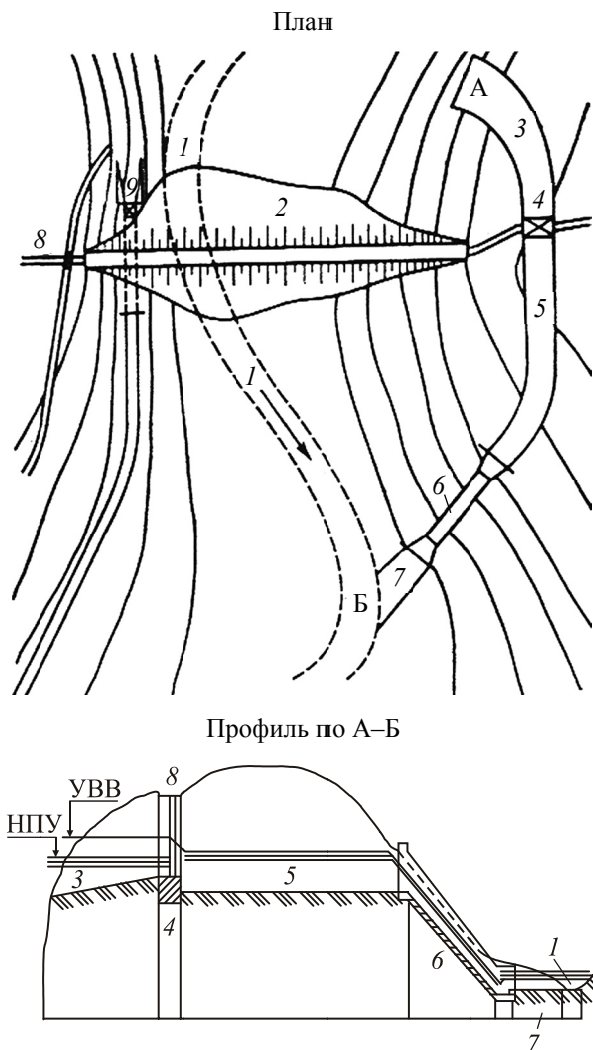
Схема гидроузла с грунтовой плотиной и открытым береговым водосбросом и водовыпуском:
